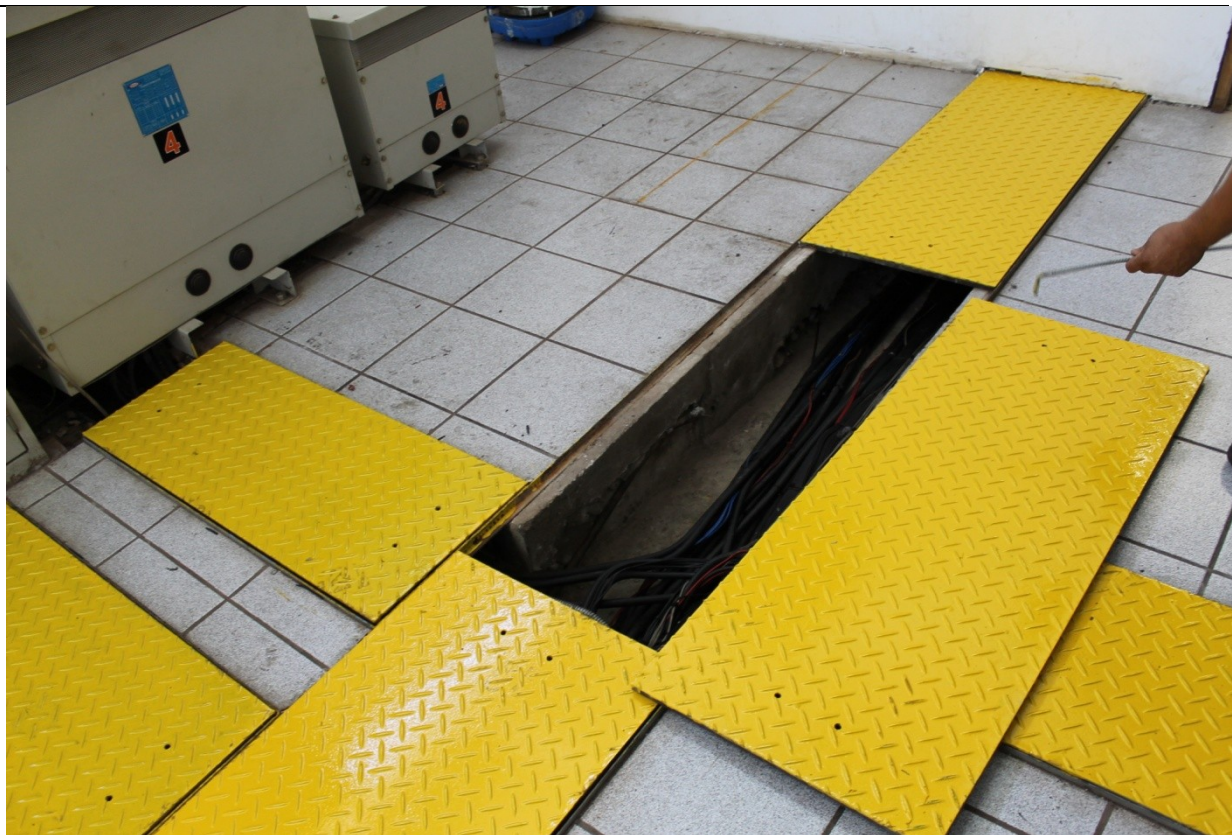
Canaletas de piso na casa de máquinas dos elevadores do edifício Anexo I para passagem dos cabos.
